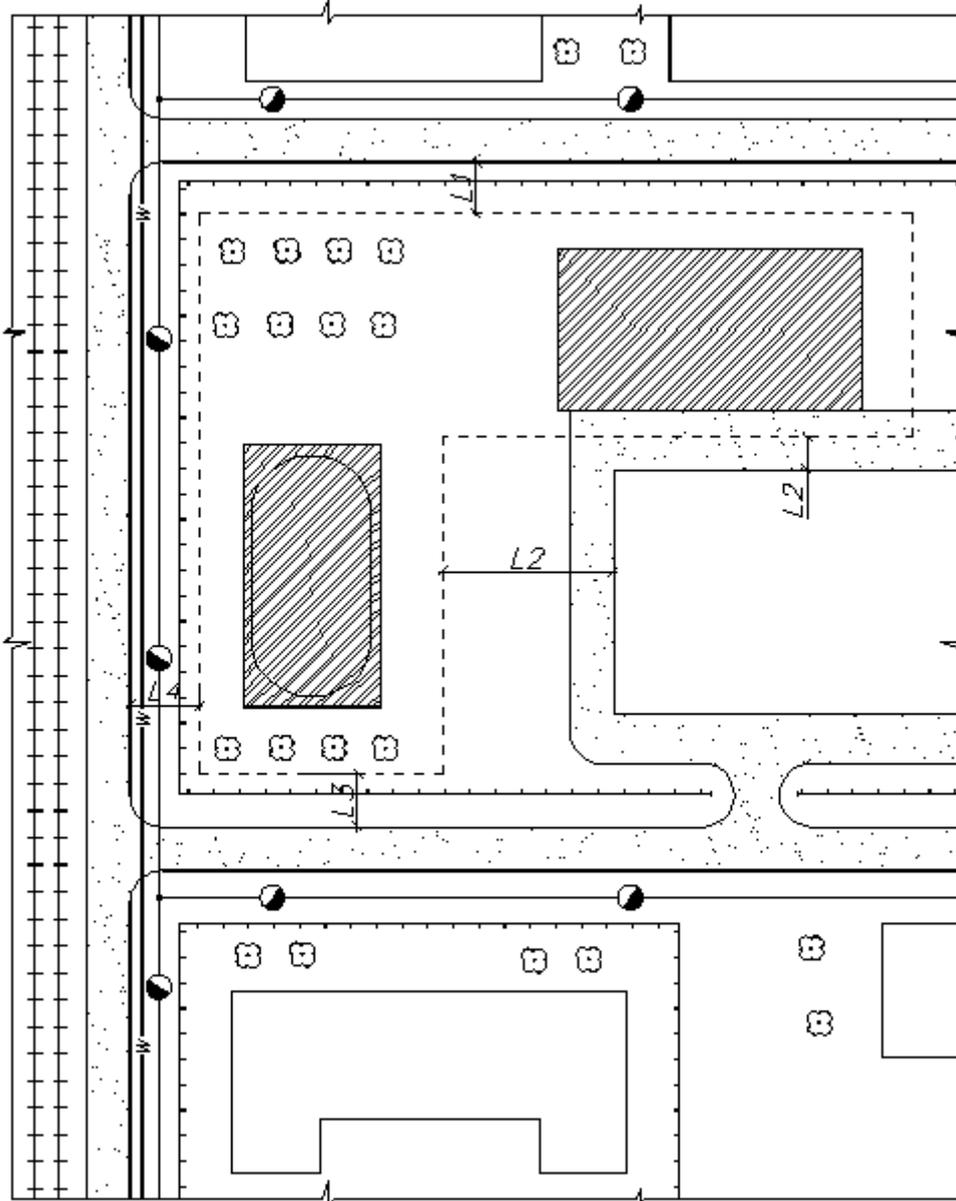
Схема Генплана многоэтажного здания (вариант2)
